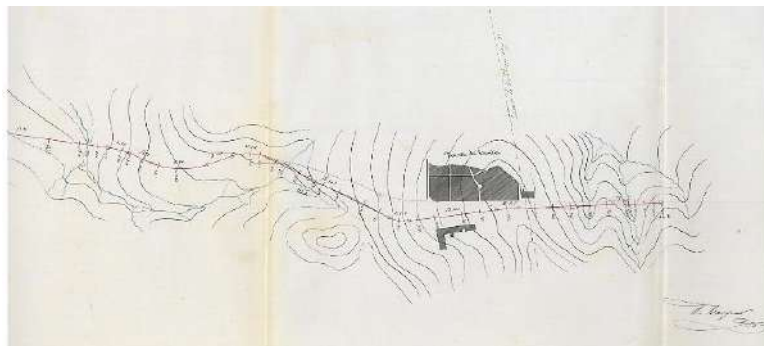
Detalles del Proyecto de 1861. Plano del tramo en torno a Fuente de Cantos
